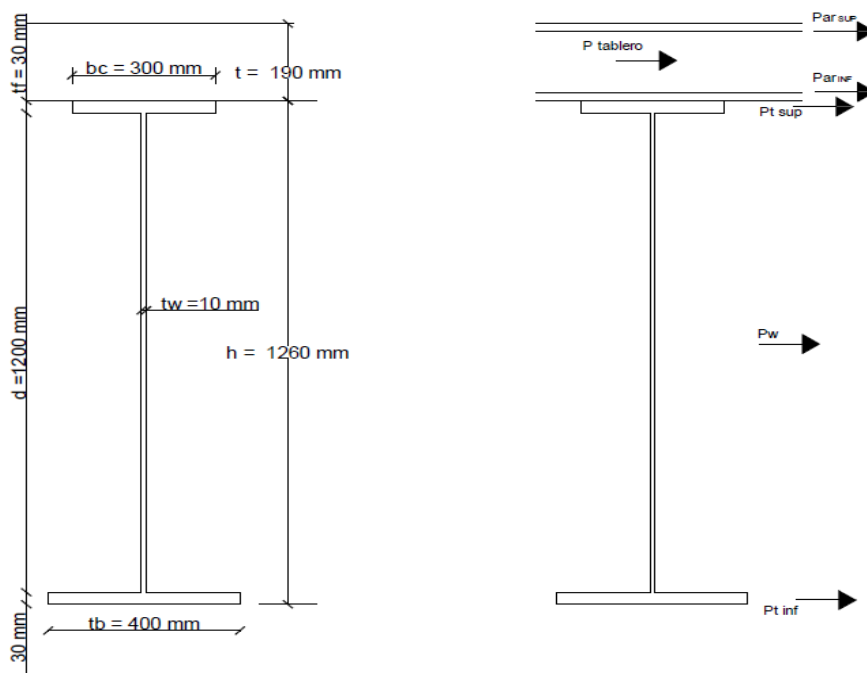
Carga resistente por los elementos del tablero y viga. Elaborado por: Autor
